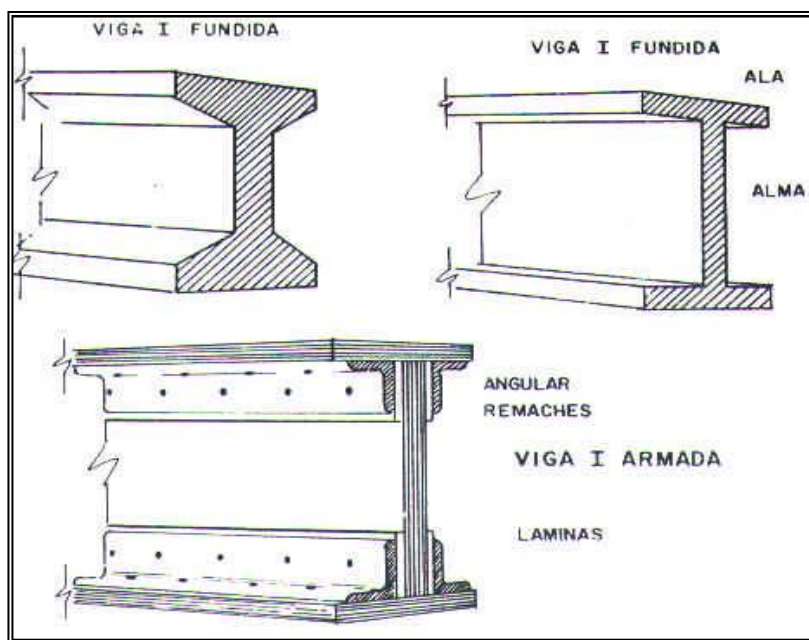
Secciones transversales típicas de vigas de acero tipo I⁵⁶.
